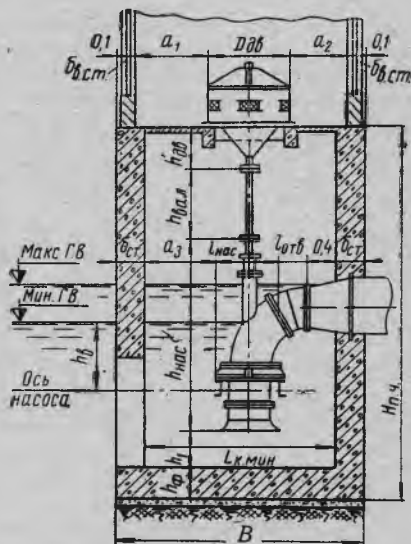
Схема к определению основных размеров здания насосной станции с мокрой камерой (поперечный разрез).
